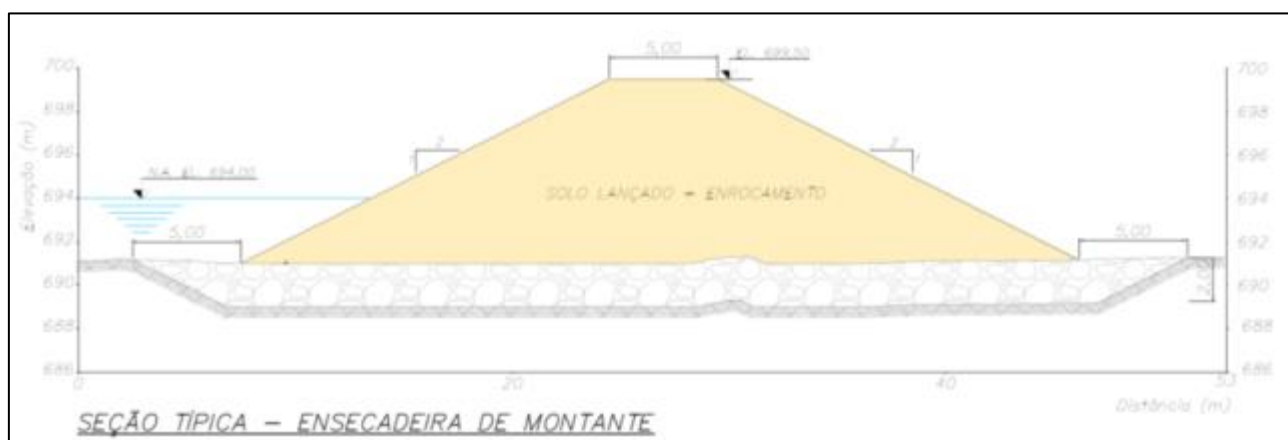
Seção típica – Ensecadeira de Montante – Projeto Detalhado Dique S4.
